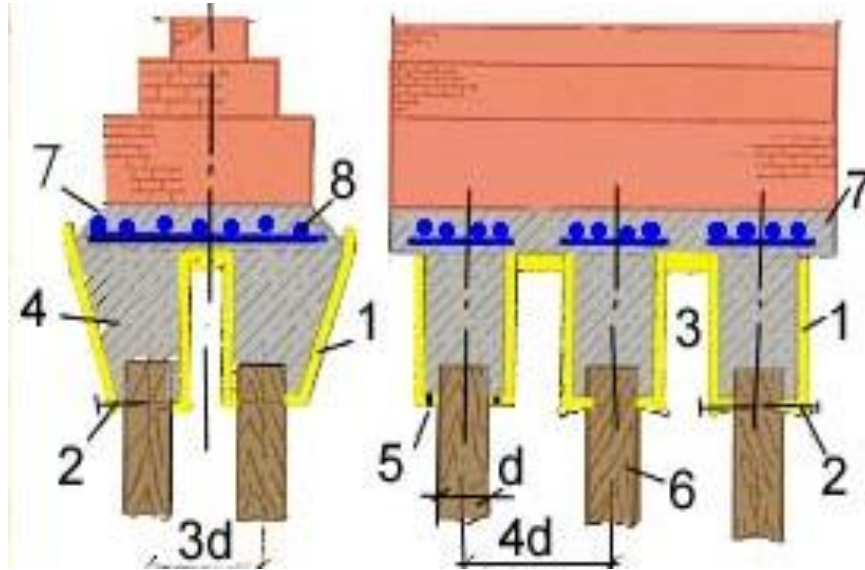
Усиление деревянных свайных фундаментов: 1 – гидроизоляция, 2 – уплотненный грунт, 3 – обратная засыпка; 4 – ЖБ оголовок; 5 – антисептическая обработка деревянного оголовка сваи; 6 – здоровая часть деревянной сваи, 7 – ЖБ ростверк под стену, 8 – арматура $\Phi 12 A400$
